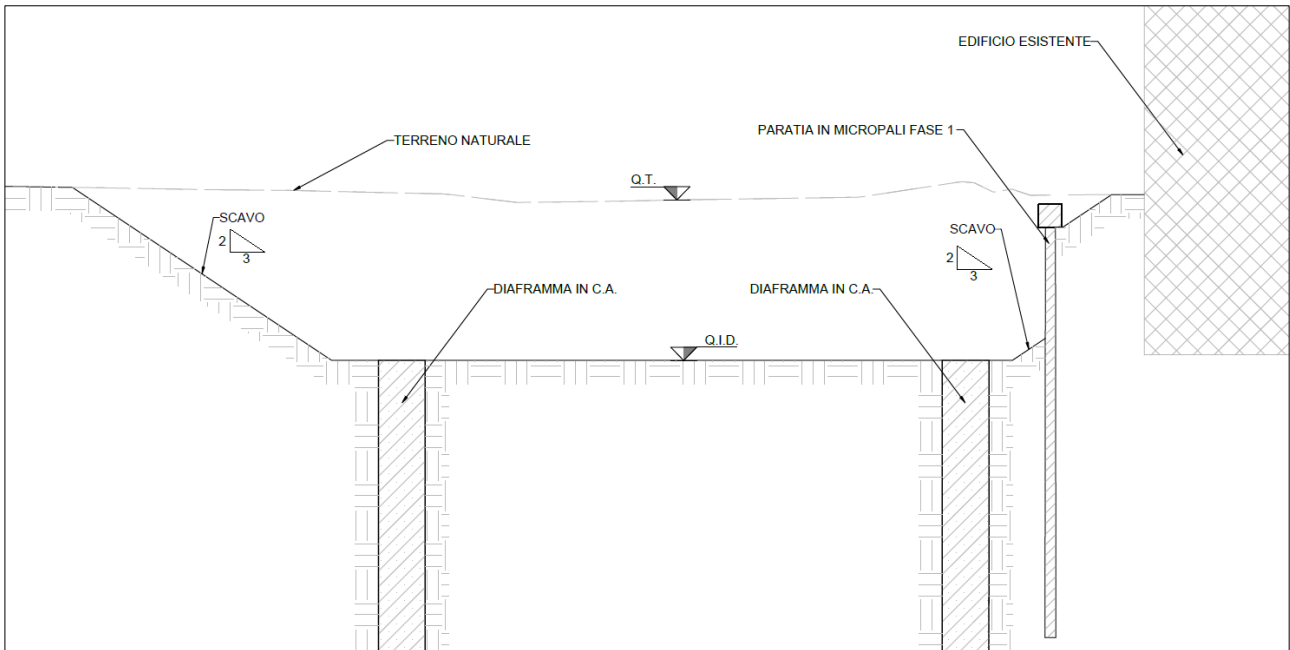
Fasi realizzazione copertura galleria del Piano di Sicurezza di progetto illustrativo della fase A di scavo della galleria
